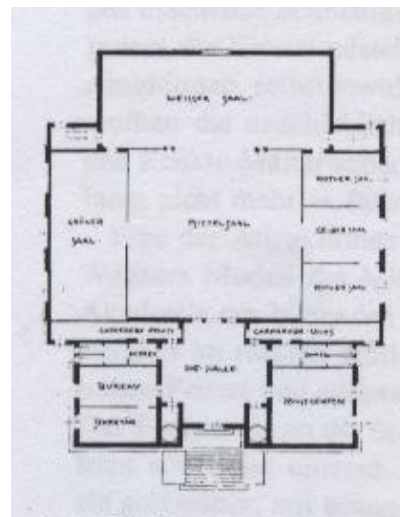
Olbrich: Grundriss, 2. Secessionsausstellung, 1898
